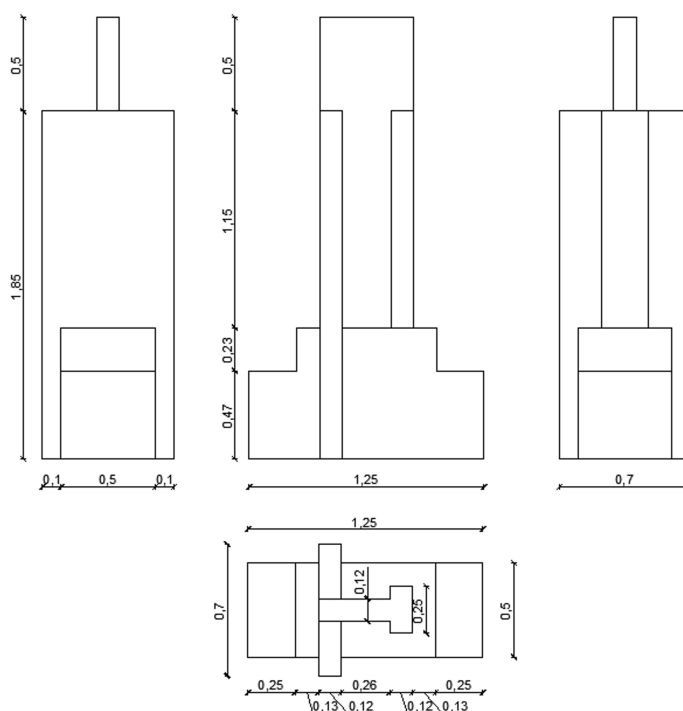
Geometria da ligação viga-pilar (dimensões em metros). Retirado de [34].
